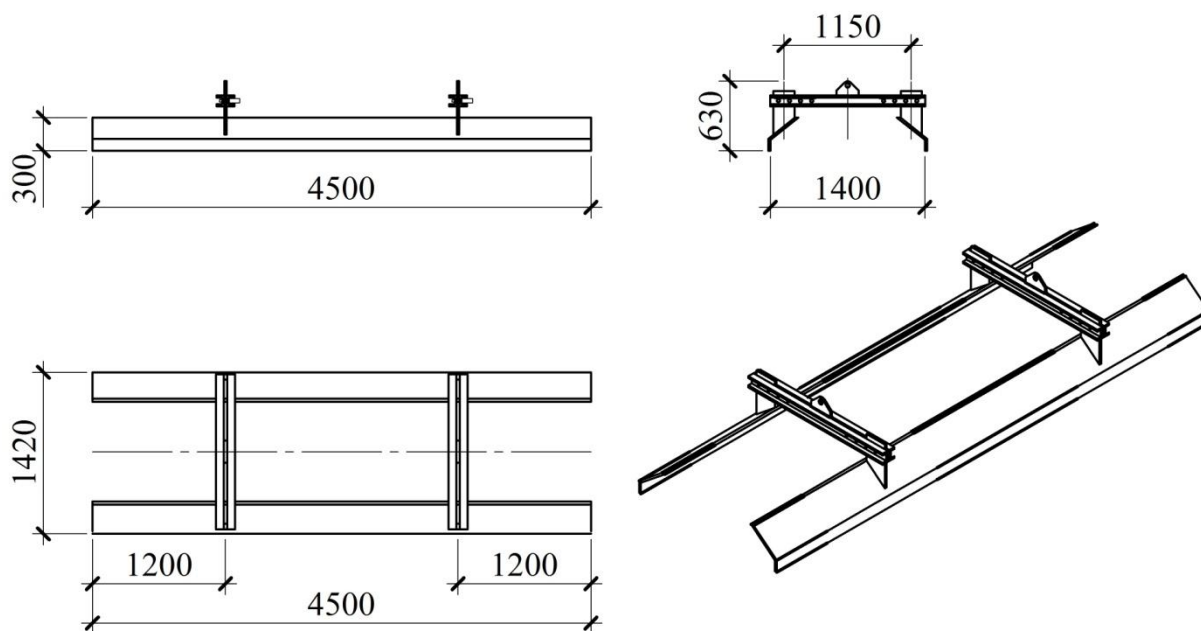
Конструкция блок-формы опалубки для возведения плит монолитных ленточных фундаментов
